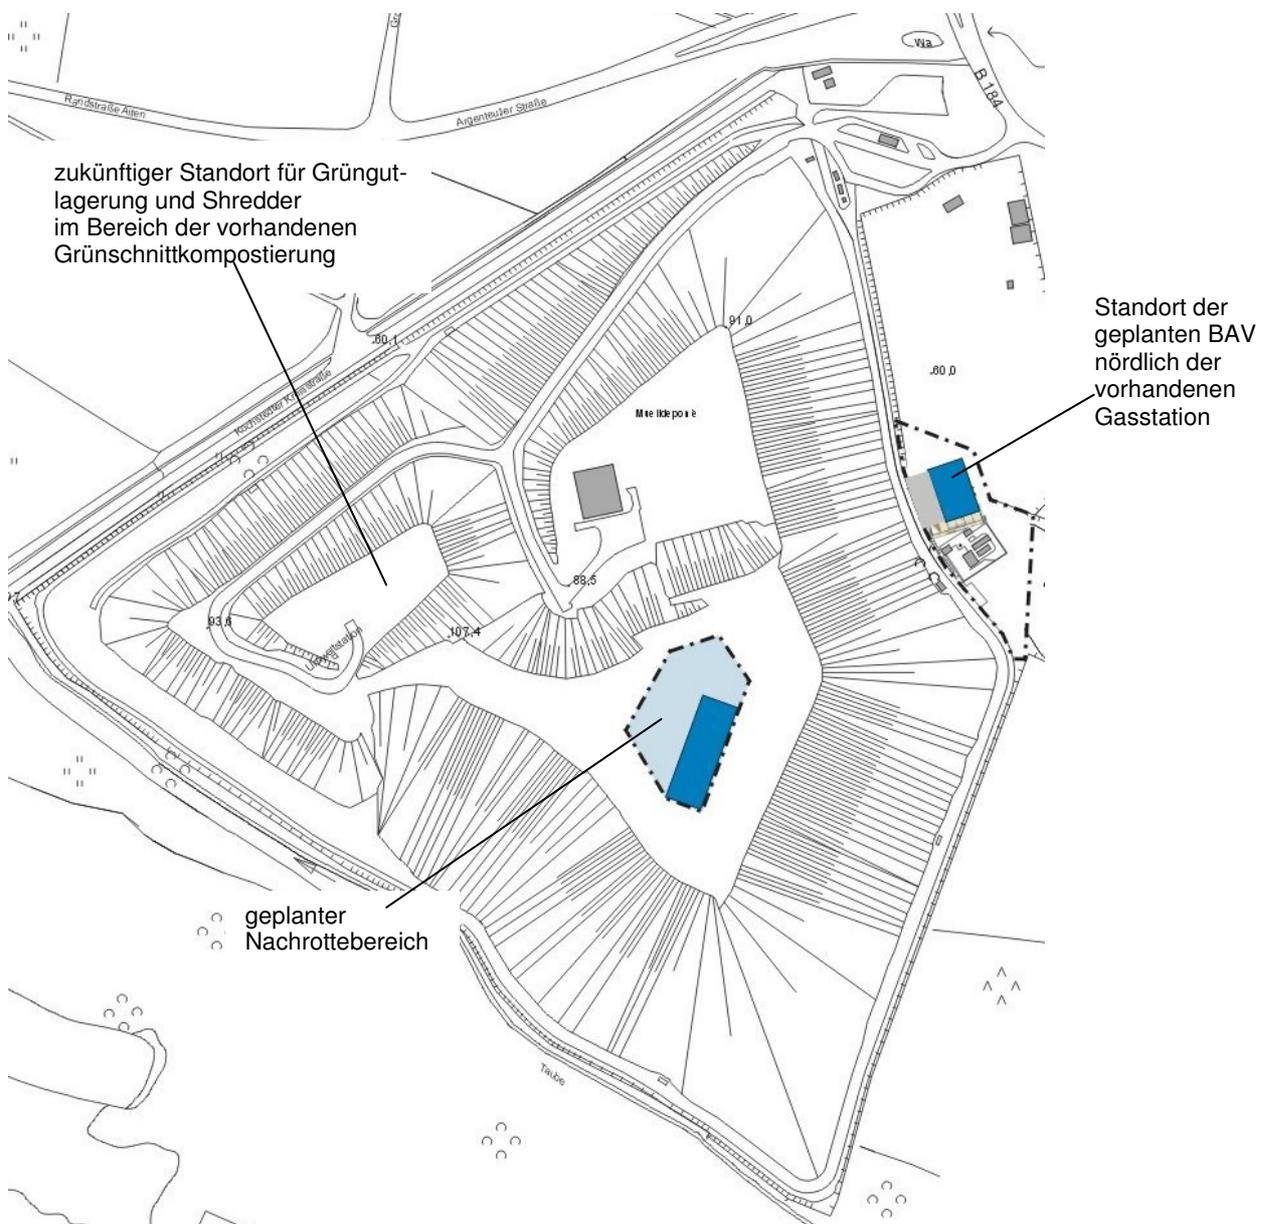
Lageplan Deponie mit geplanten Anlagenbereichen
